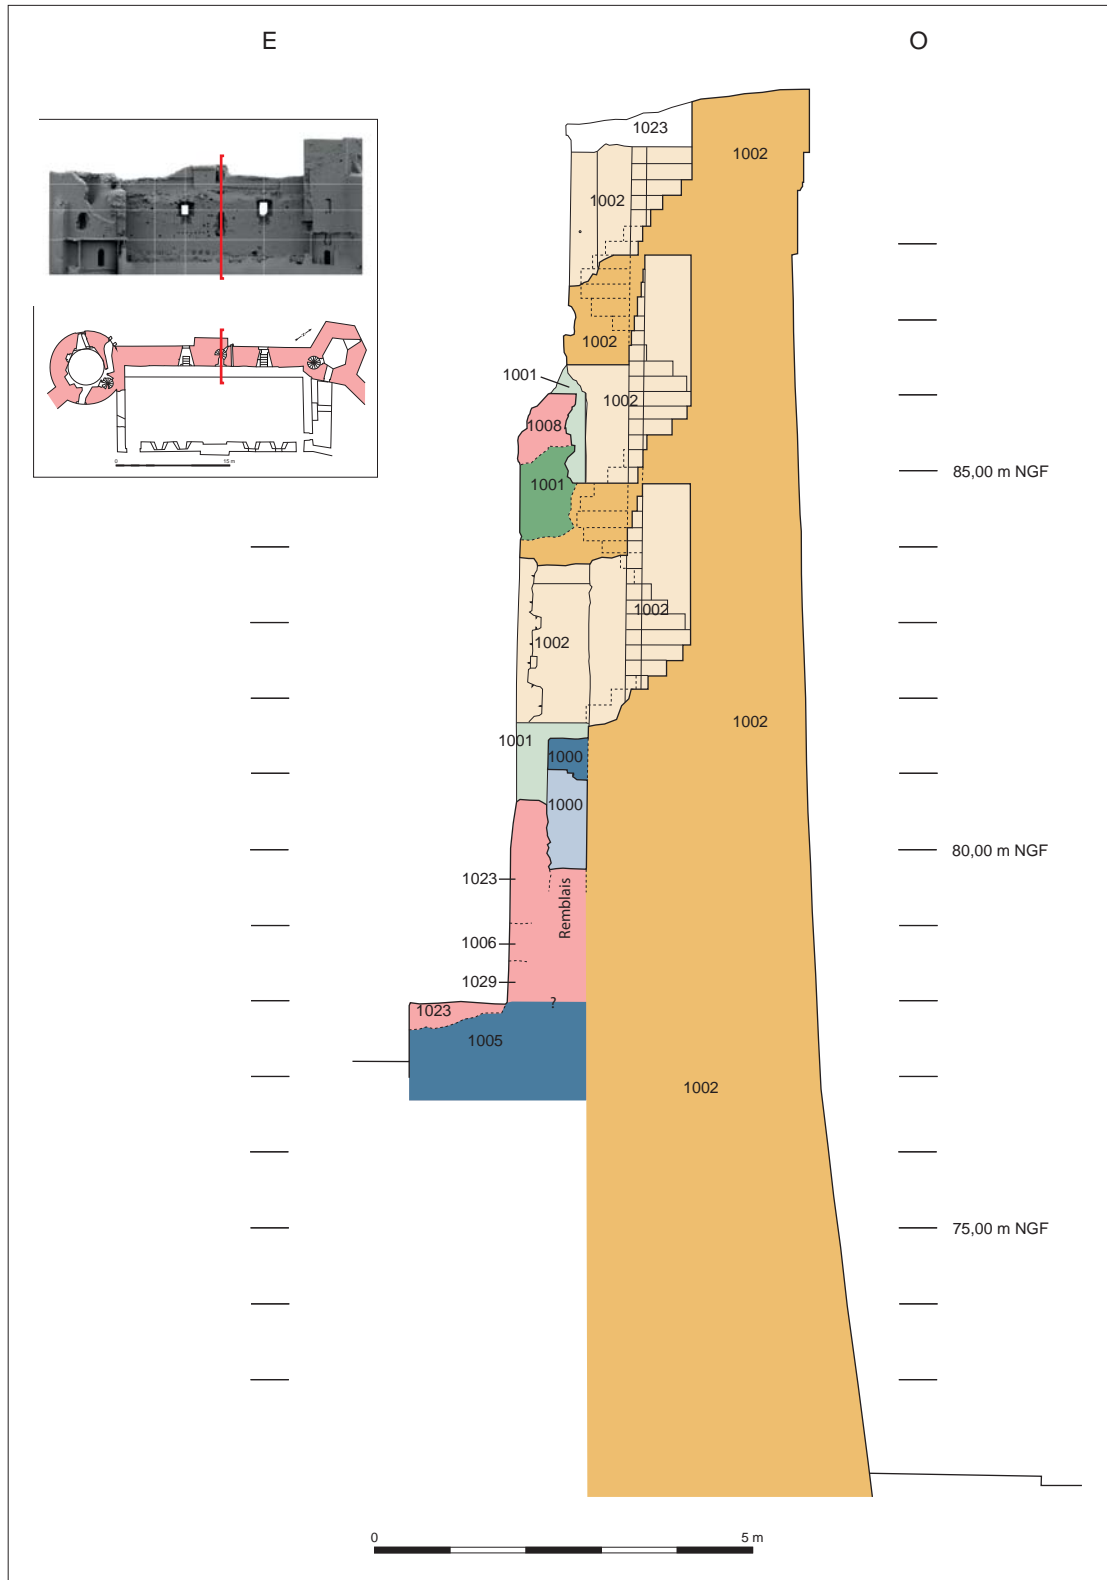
Coupe transversale vers le sud de la courtine ouest, au niveau de l'escalier en vis.
